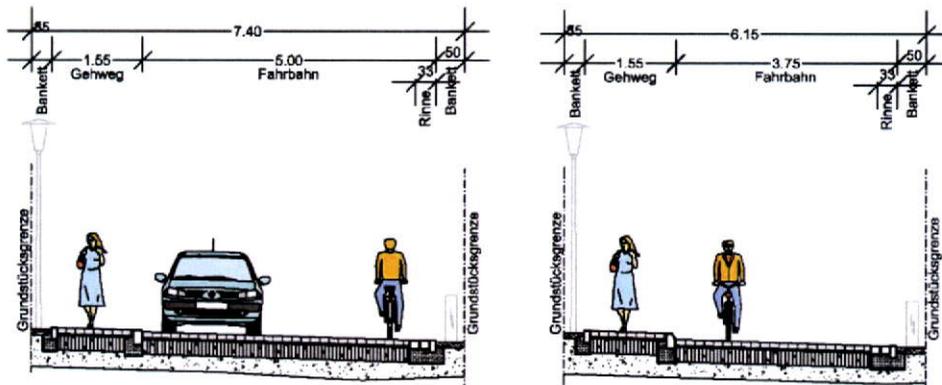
Regelquerschnitt Planstraße K sowie Regelquerschnitt Einengungsbereich
